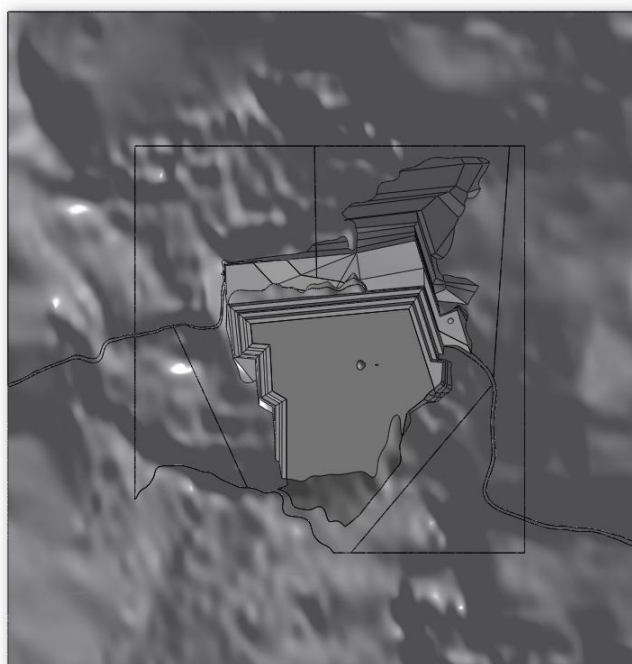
Modello geometrico 3D progetto di coltivazione a 10 anni – vista planimetrica
